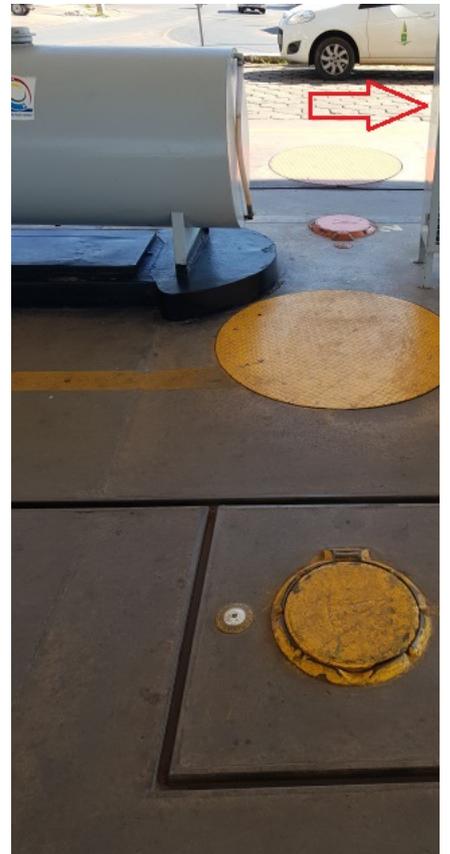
Local de venda de lubrificantes, armazenados em canaletas
